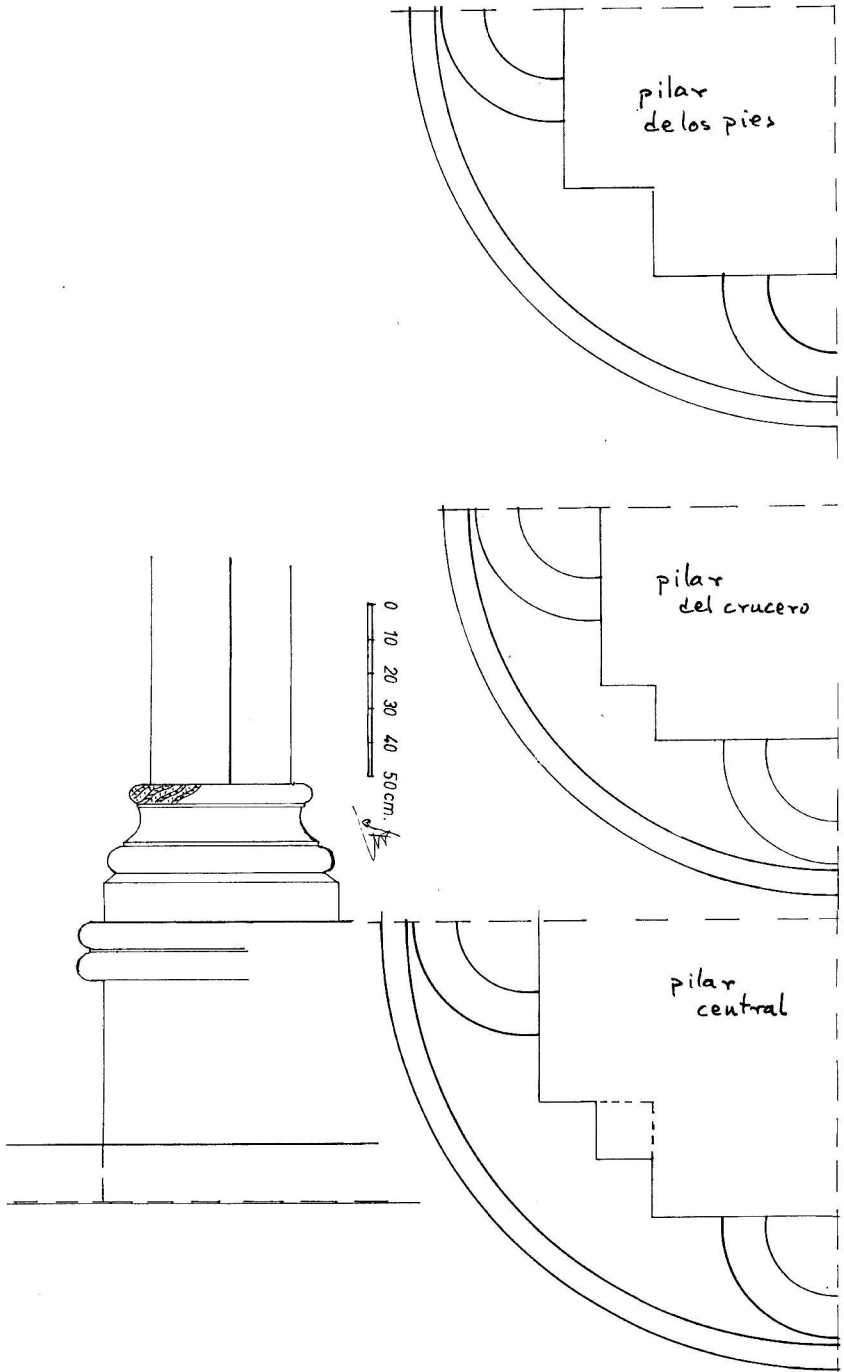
Planta de los pilares y alzado de las basas de las columnillas.
